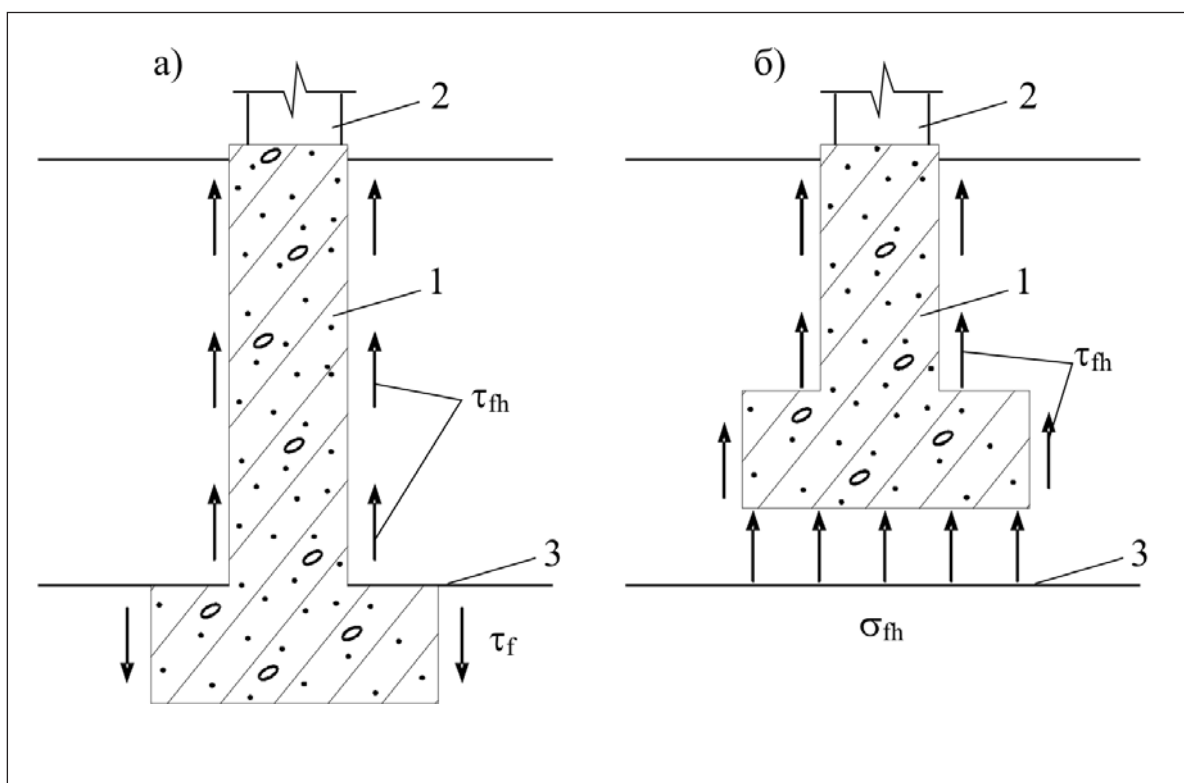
Конструкции фундаментов в пучинистых грунтах: а – заглубленные фундаменты ниже глубины промерзания; б – заглубленные фундаменты не на всю глубину промерзания: 1 – фундамент; 2 – стена; 3 – нижняя граница глубины промерзания;
